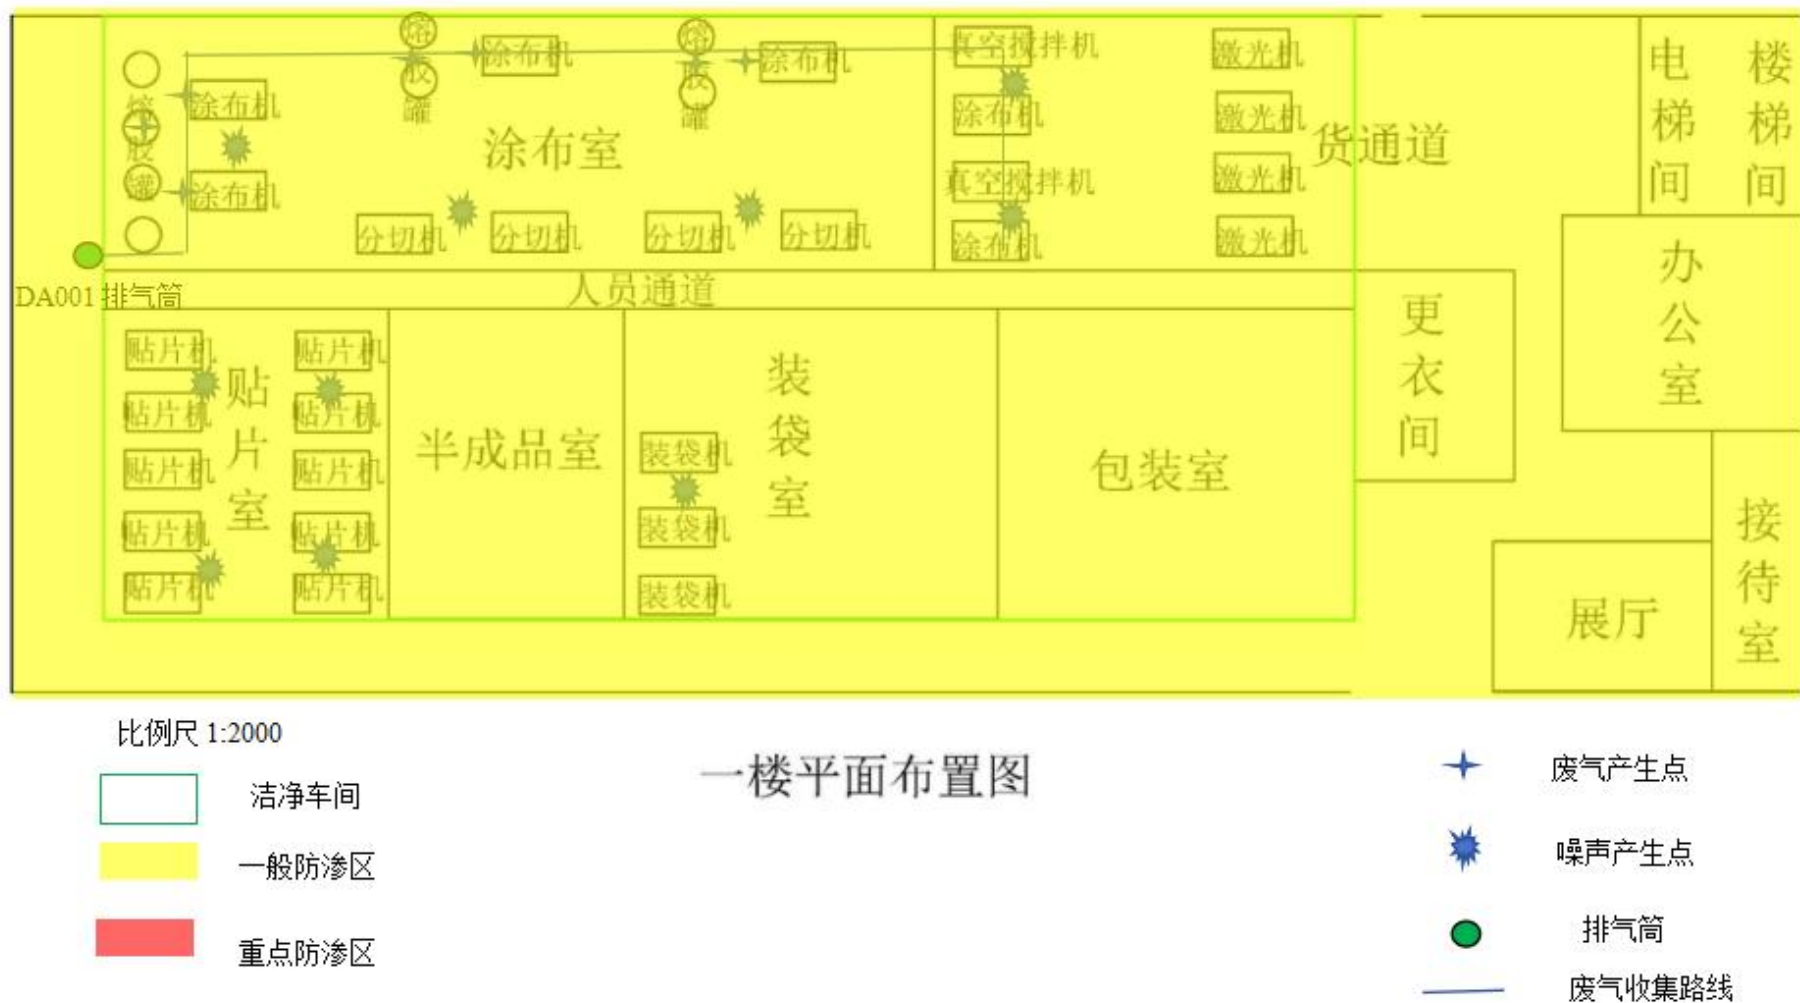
环评-厂区生产车间一楼平面布置图（1）
